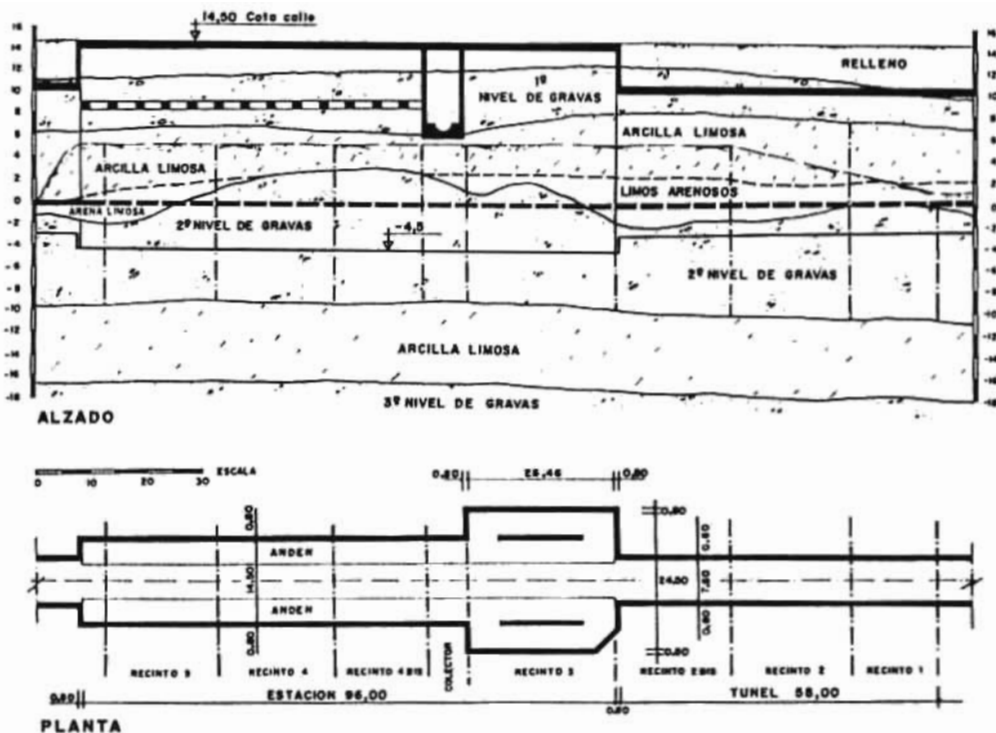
Planta y perfil longitudinal de la Estación Giorgeta y del túnel contiguo
